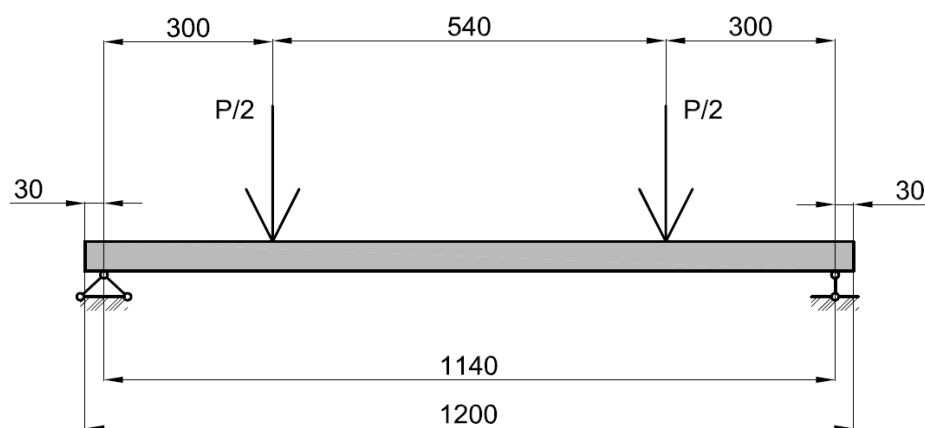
Схема випробування залізобетонних плит ЗБНО
